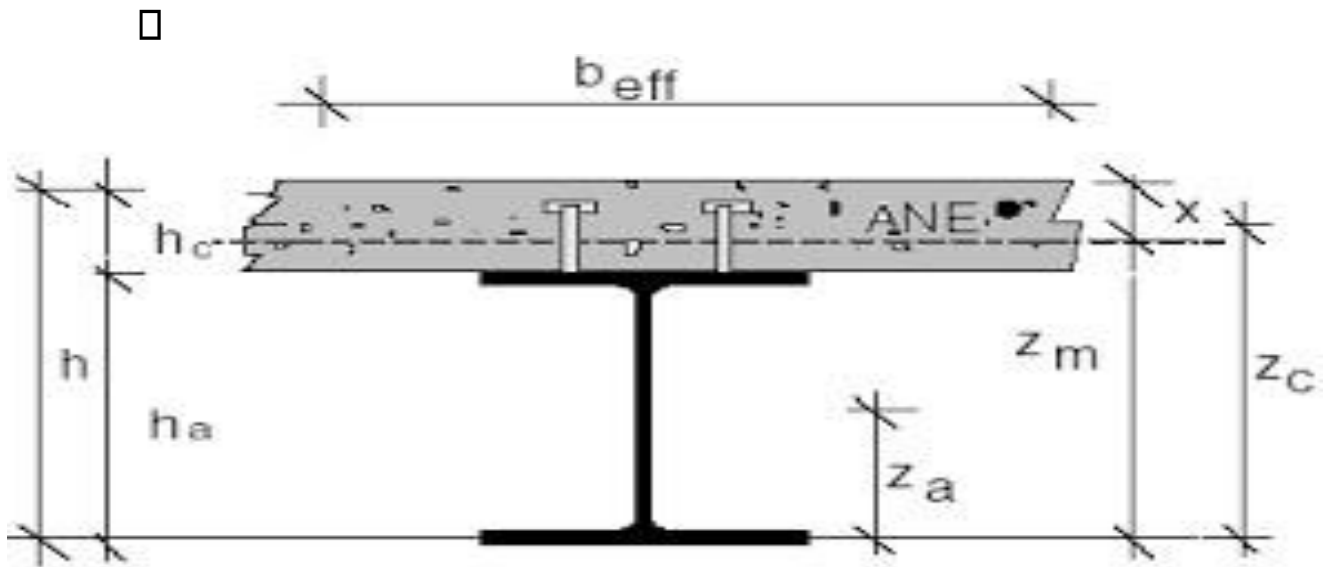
3 : schéma de section mixte (axe neutre dans la dalle).
